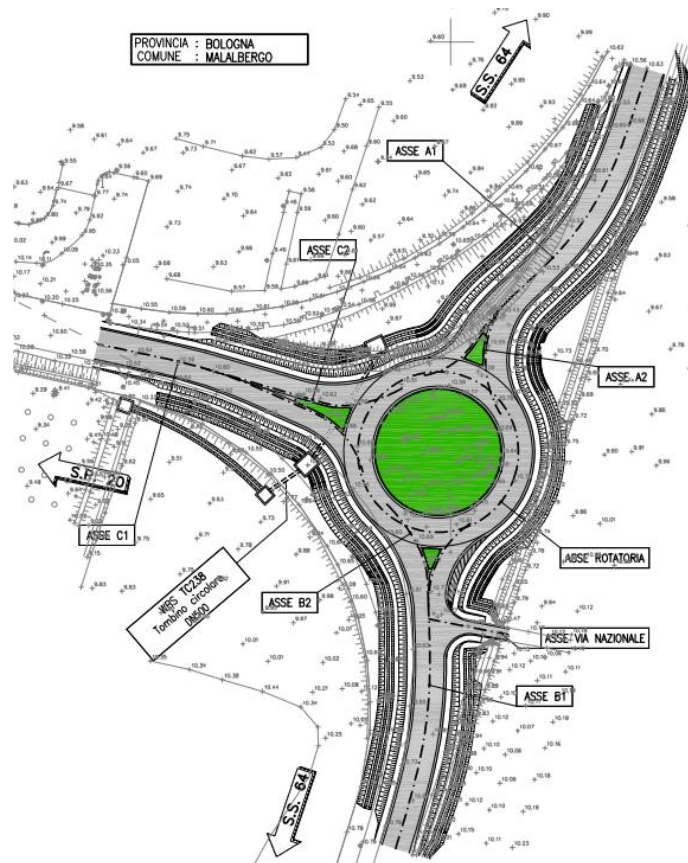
Figura C: Stralcio planimetrico rotatoria SP 20 – SS 64
